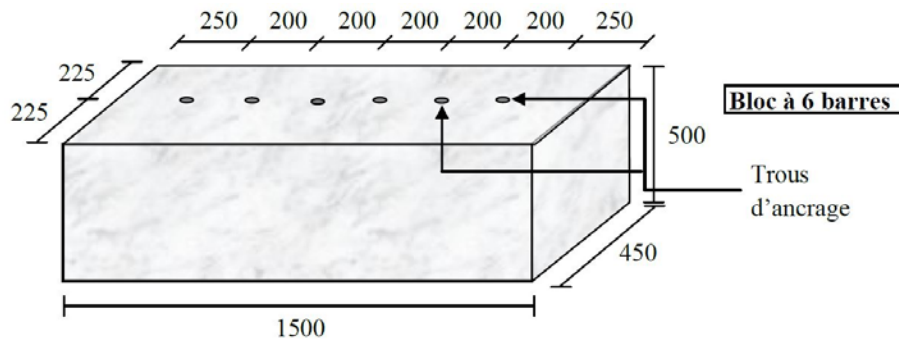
Substrat de béton typique utilisé pour installer les ancrages cimentaires
